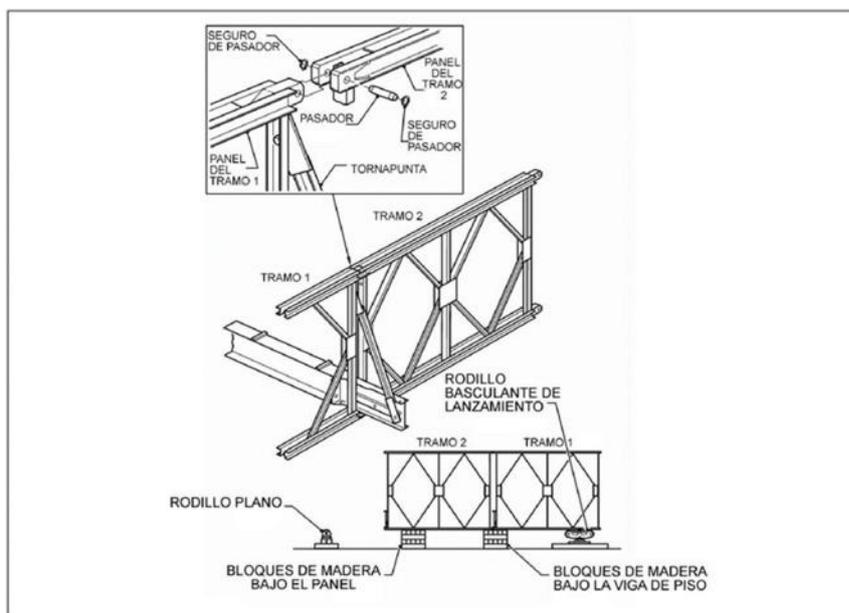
Posición de tacos de madera en la primera viga de piso
